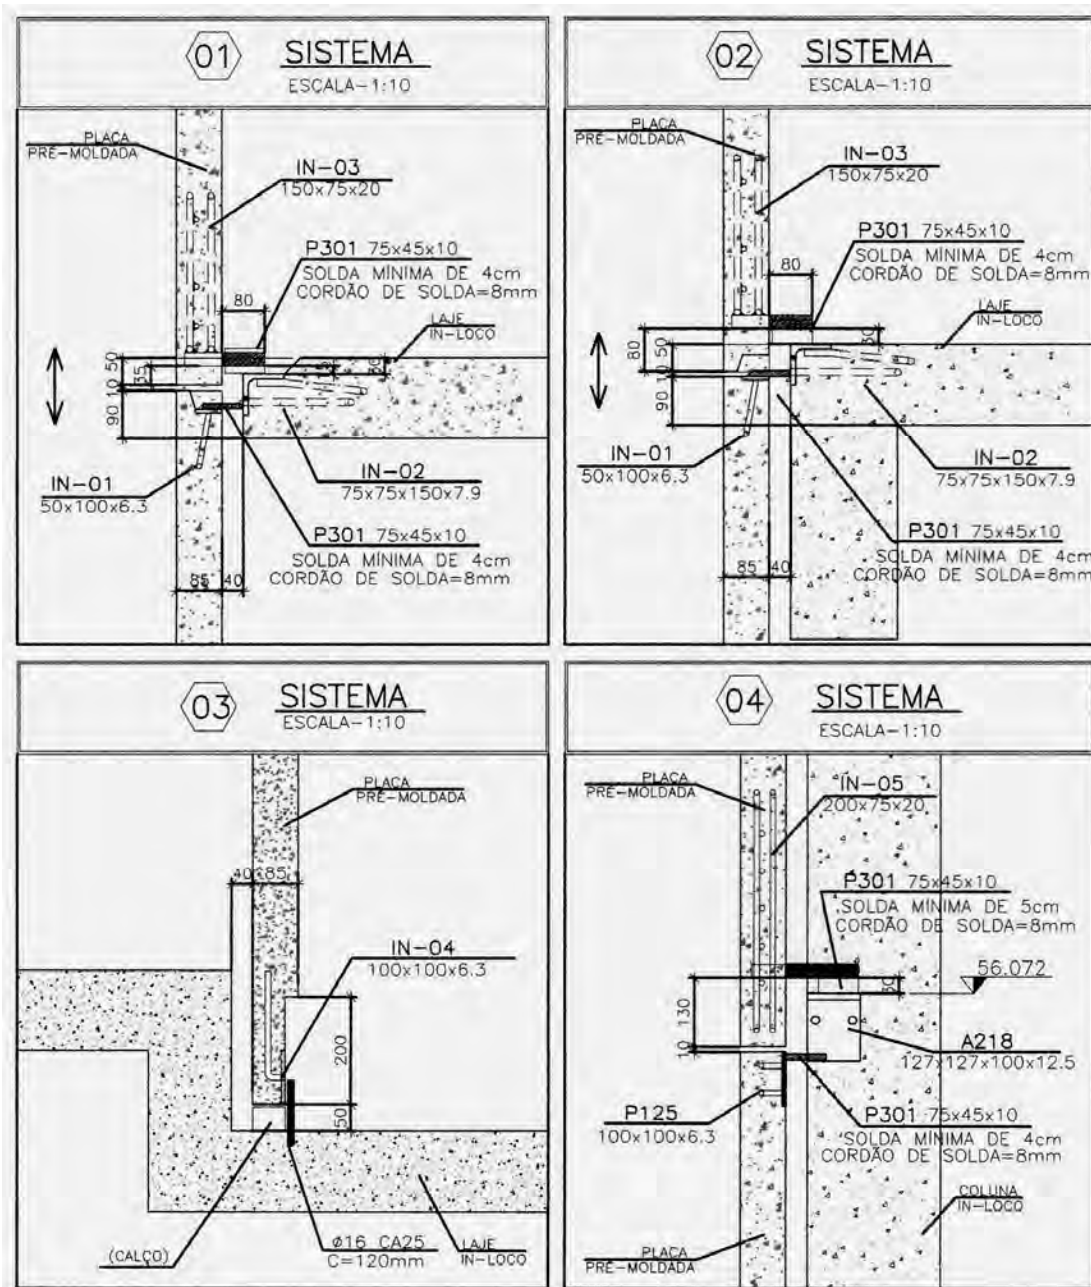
Detalhe dos encaixes do painel pré-fabricado da fachada. O sistema reduziu a produção de resíduos e deu velocidade à obra.
